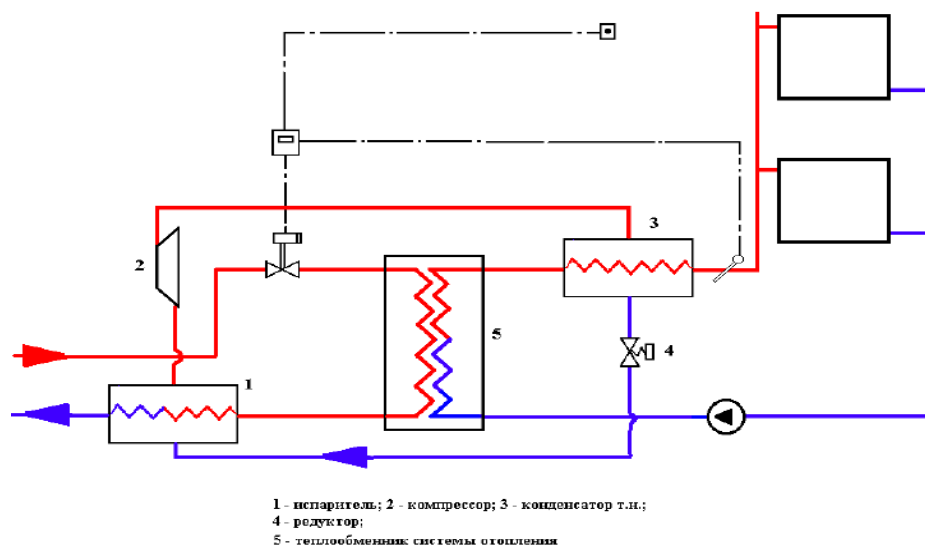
Схема теплового пункта с тепловым насосом на подающем трубопроводе системы отопления
